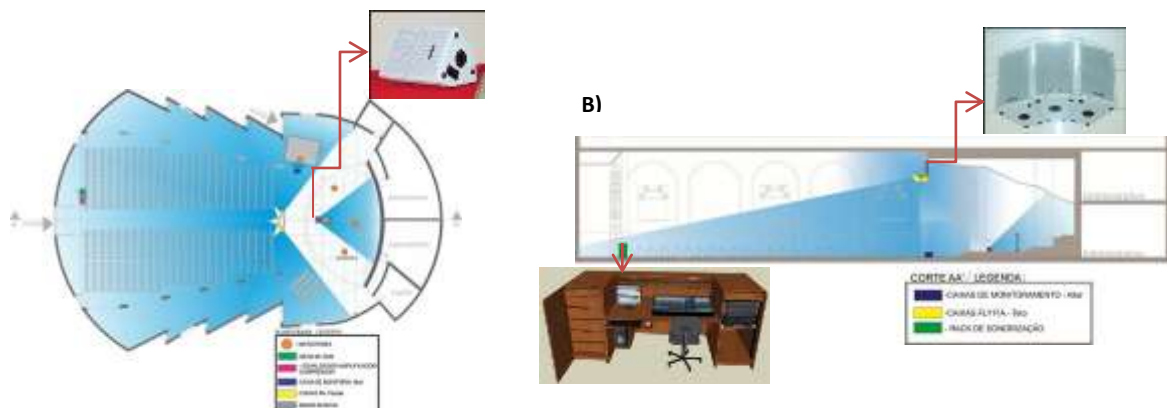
Distribuição sonorização artificial na proposta eletroacústica da Concatedral: (A) planta baixa; (B) Corte transversal.
